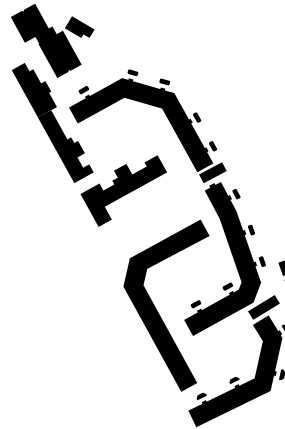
Schwarzplan der Mehrfamilienhausbebauung e.D.
